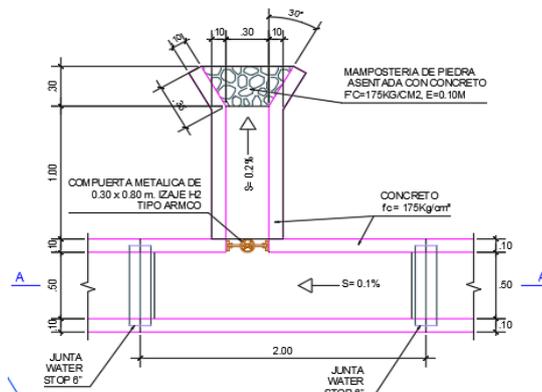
Vista en planta de toma lateral típica - alcantarilla
